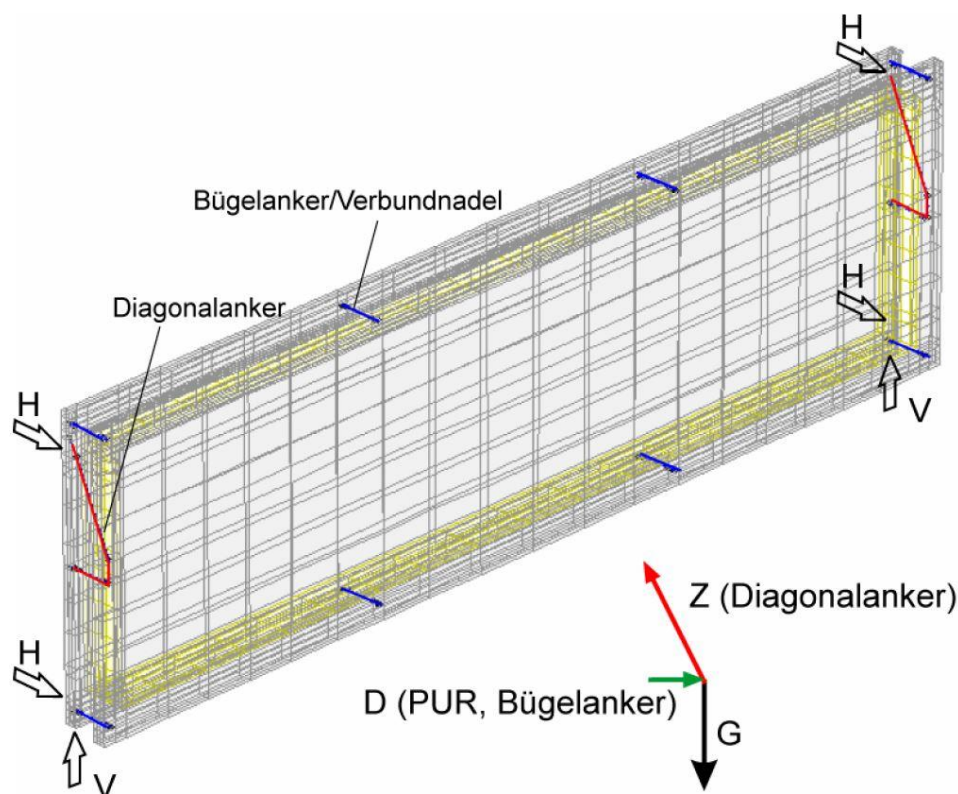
Verbindungsmittel-Anordnung an einem Sandwich-Vorhangfassadenelement aus textil bewährtem Betondeckschichten und einem Kern aus PUR-Hartschaum [Insushell09]
